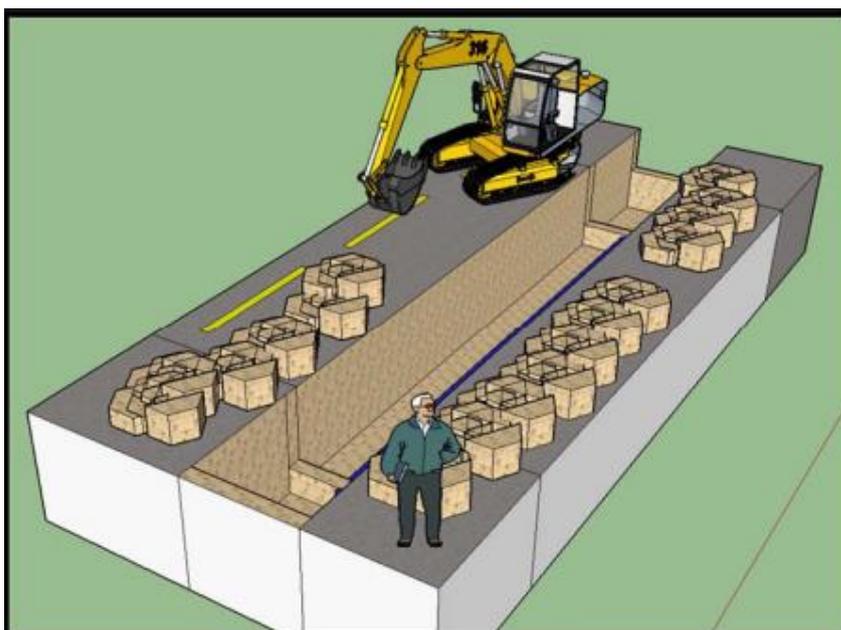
Excavación en zanja. Fuente: Paniagua & Quispe, 2017
